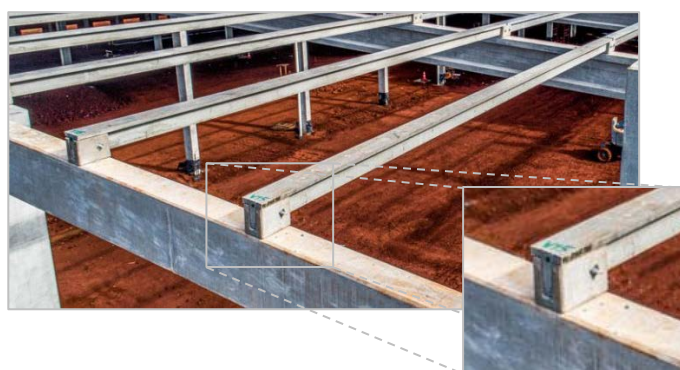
Ligação parafusada das terças aos suportes de concreto. Fonte: Adaptado de Rotesma Pré-Fabricados
